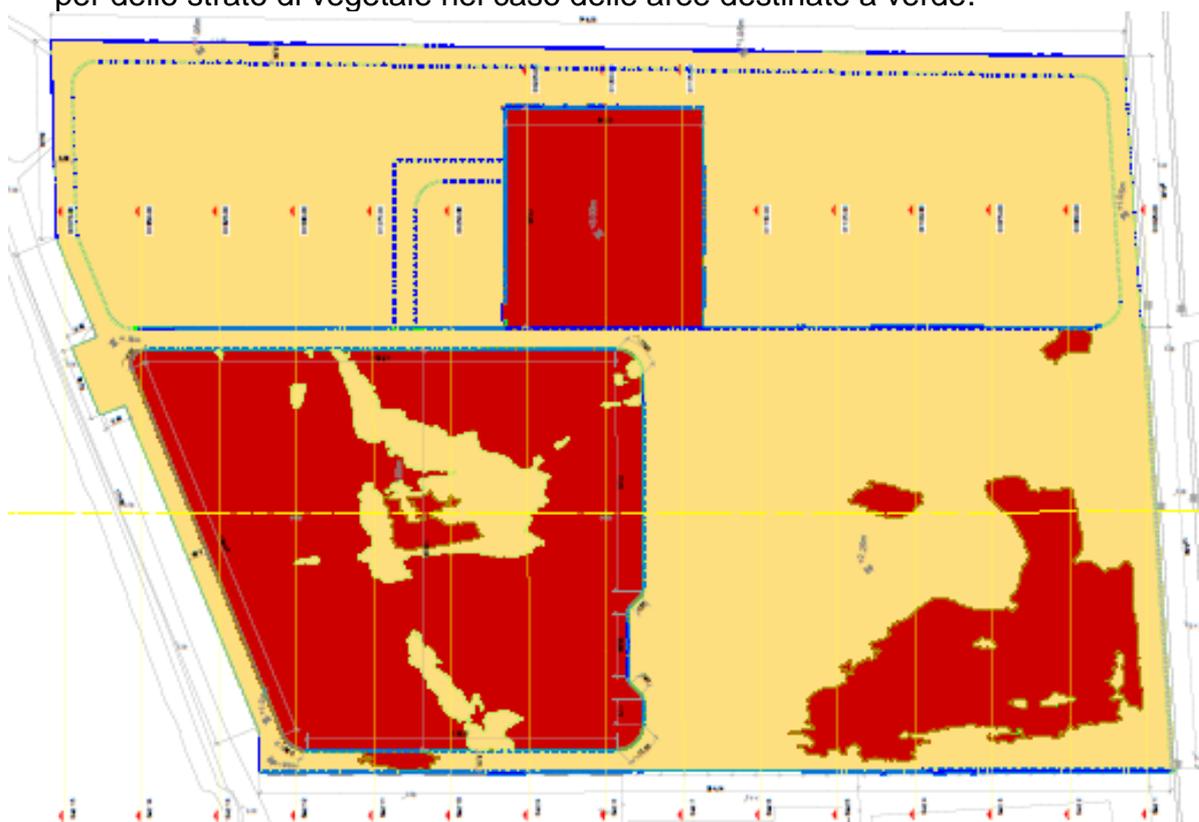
Planimetria delle aree di scavo e riporto per la sistemazione area
